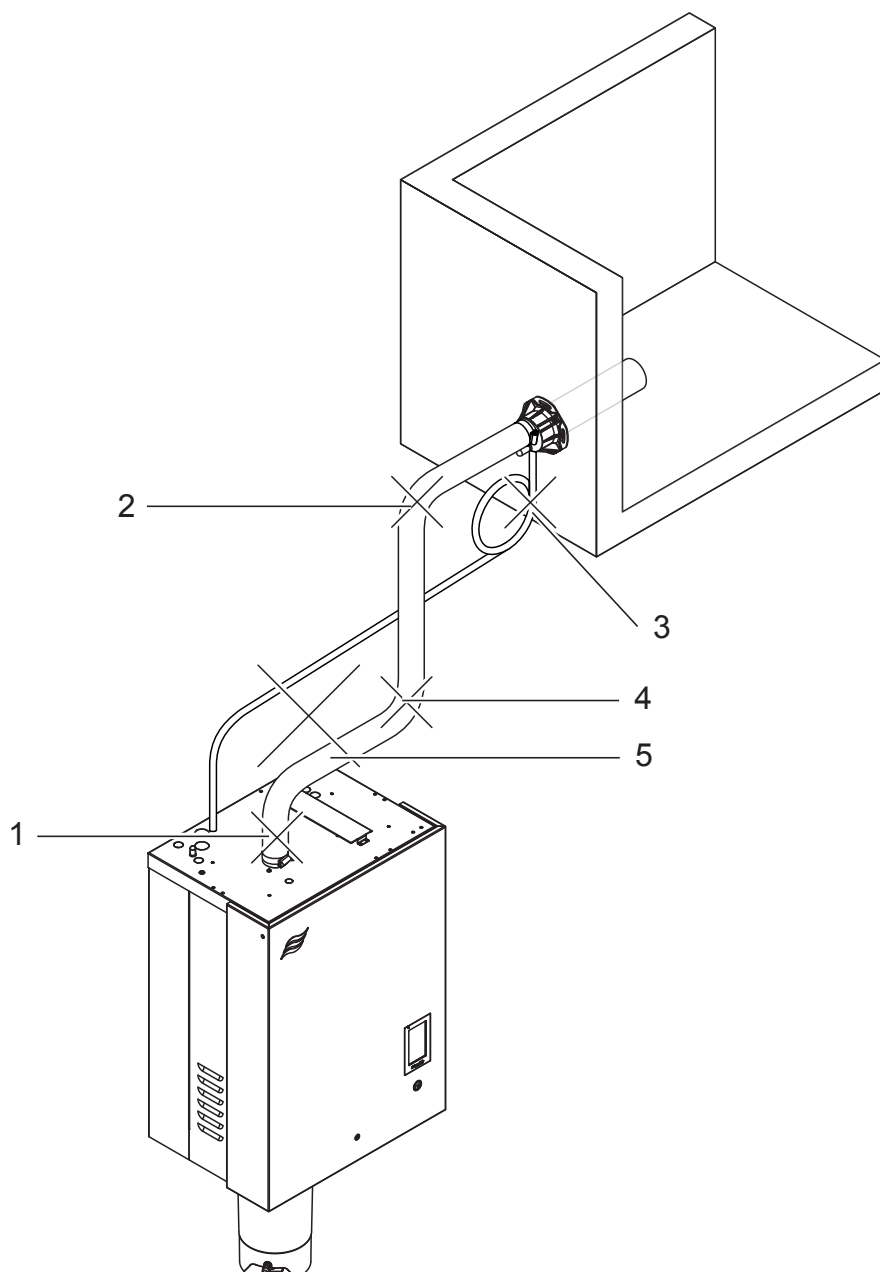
Dampfleitung mit fester Verrohrung und Isolation
